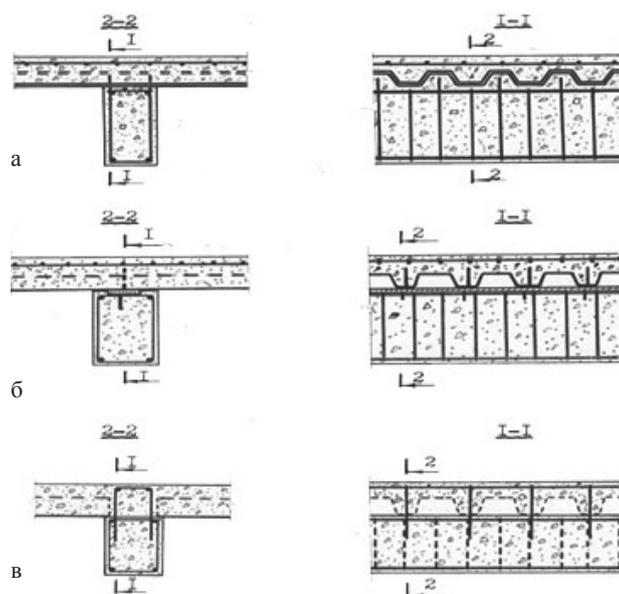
Конструкции перекрытий, возводимых по железобетонным прогонам:
